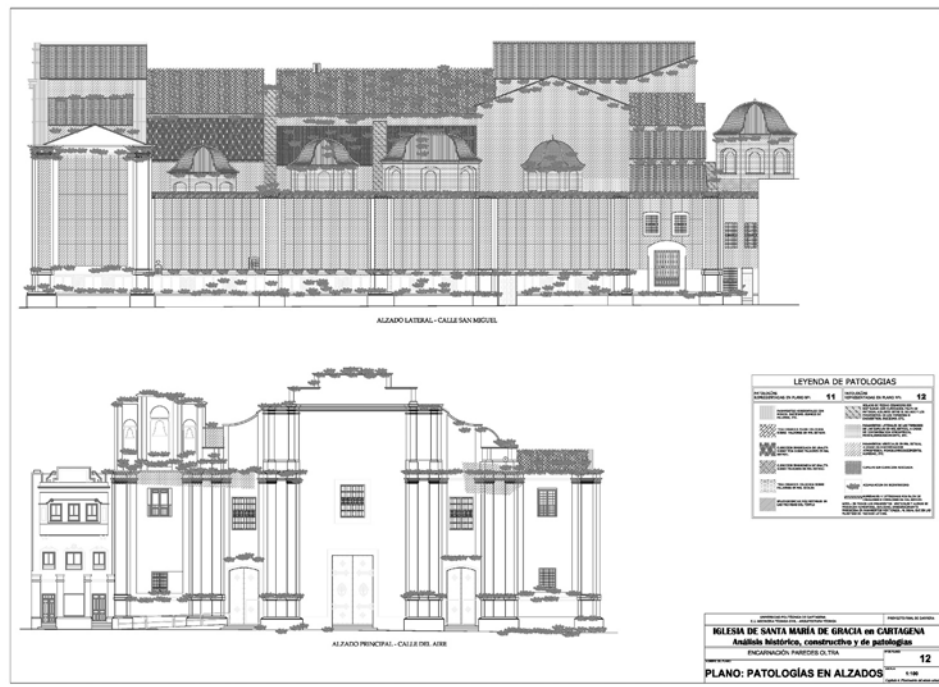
Plano de patologías del alzado principal (Calle del Aire) y alzado lateral (calle San Miguel) de la Iglesia Santa María de Gracia de Cartagena.
